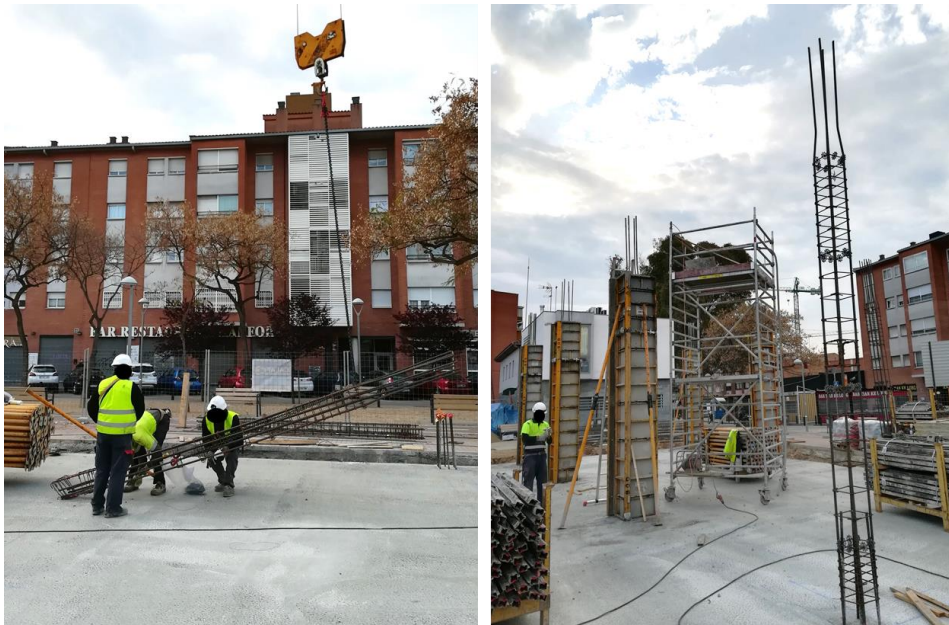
Operaris punxant els pilars de la planta baixa. *Elaboració pròpia.
